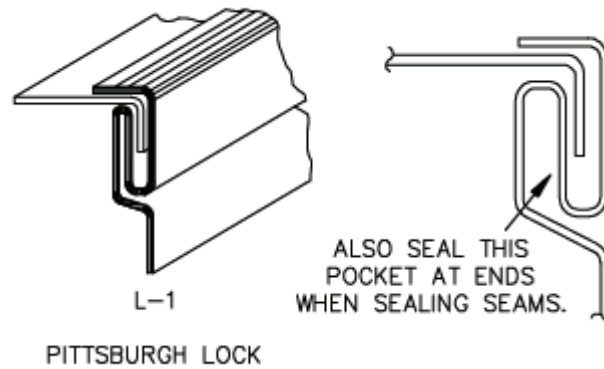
Junta longitudinal tipo Pittsburgh Lock, para ductos de extracción de aire ⁶⁸
